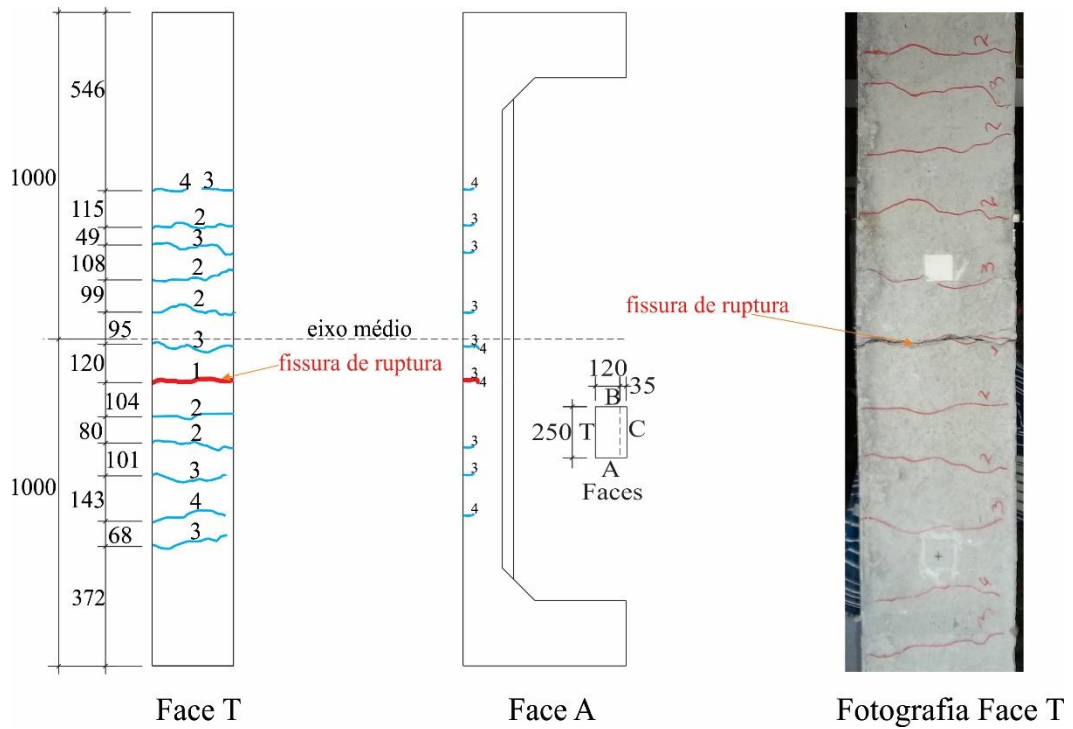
51 - Fissuras nas Faces T e A; Fotografia da face T – pilar PAF-150-18
